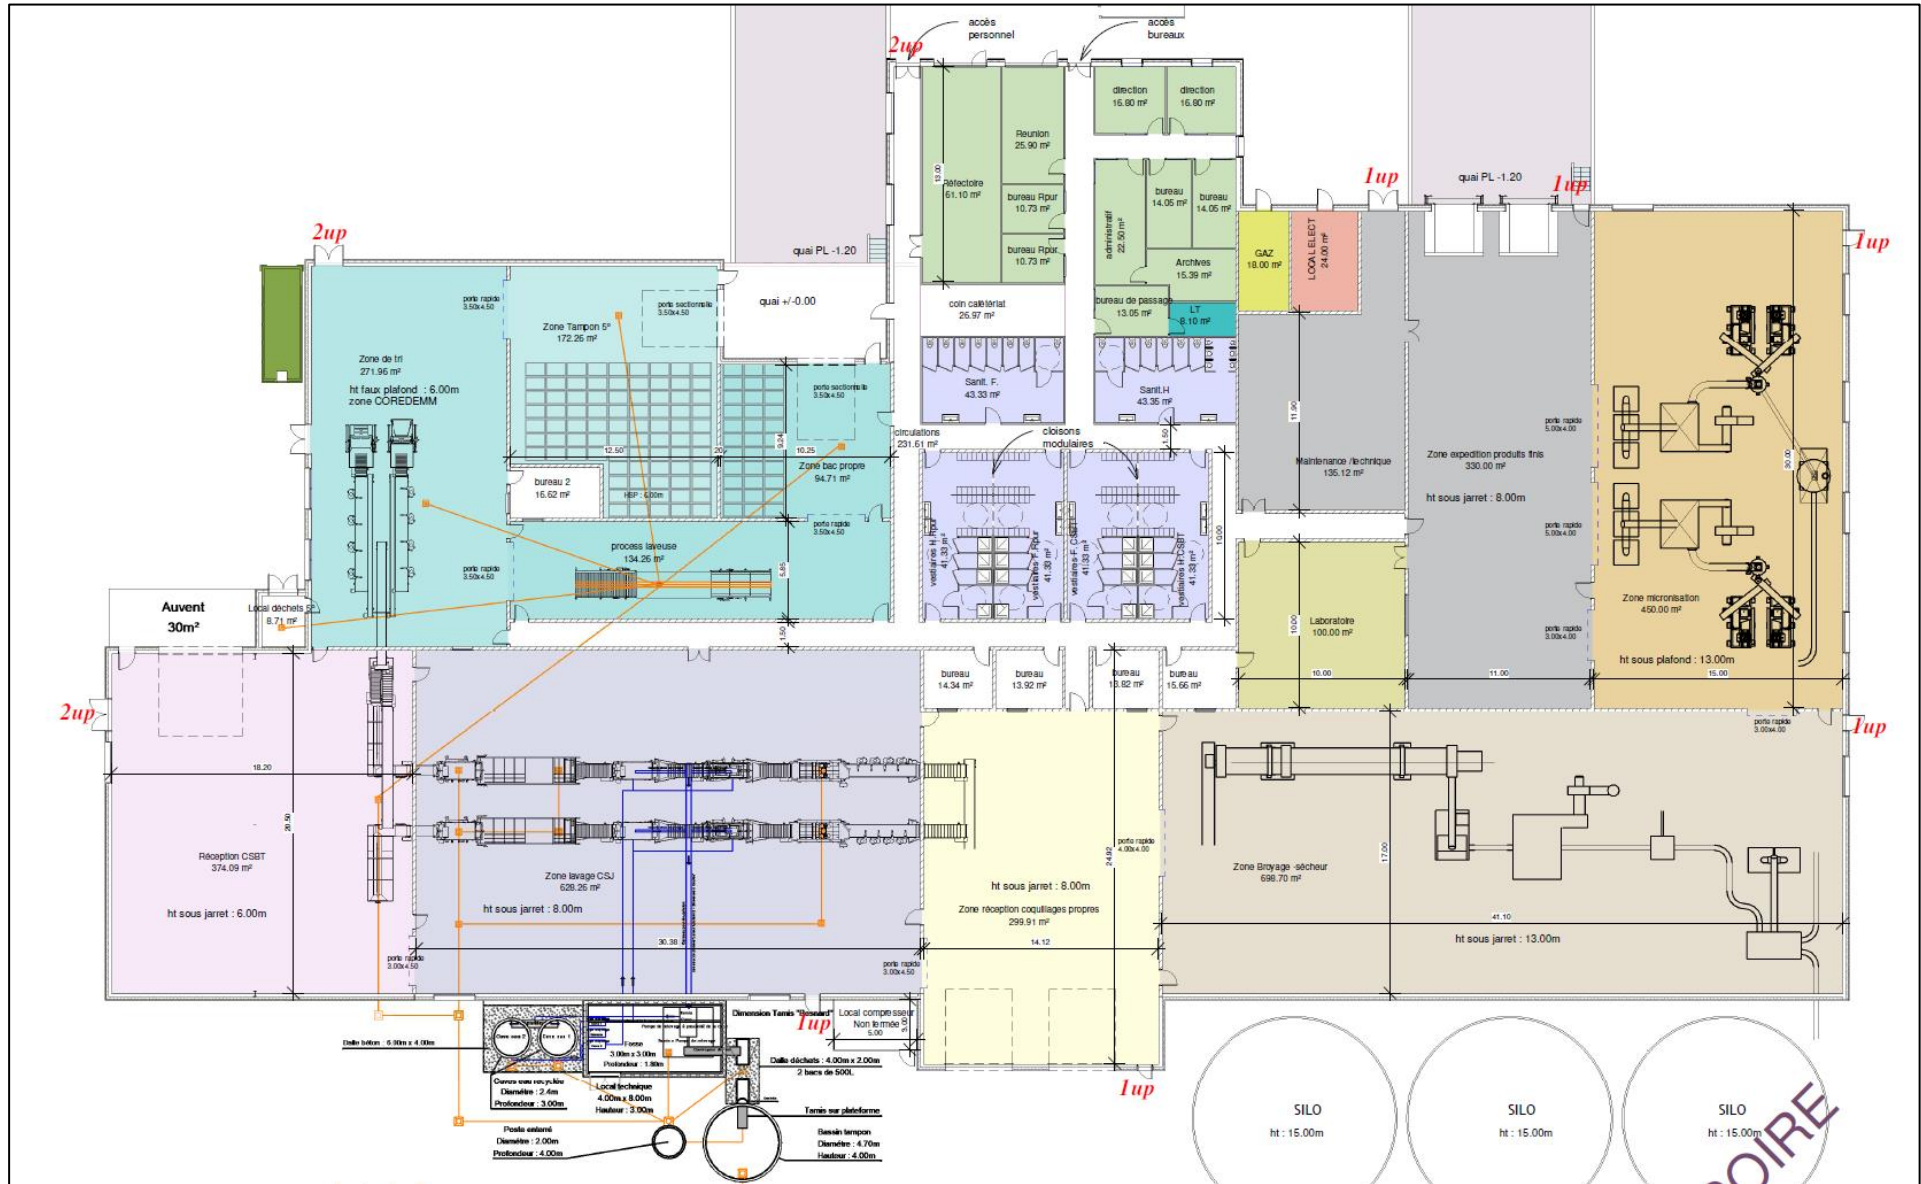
PLAN D'IMPLANTATION DU PROCEDE
